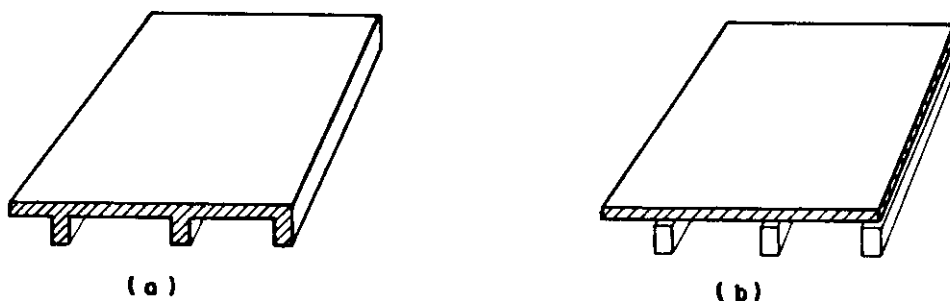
LIGAÇÃO ENTRE LAJES E VIGAS
